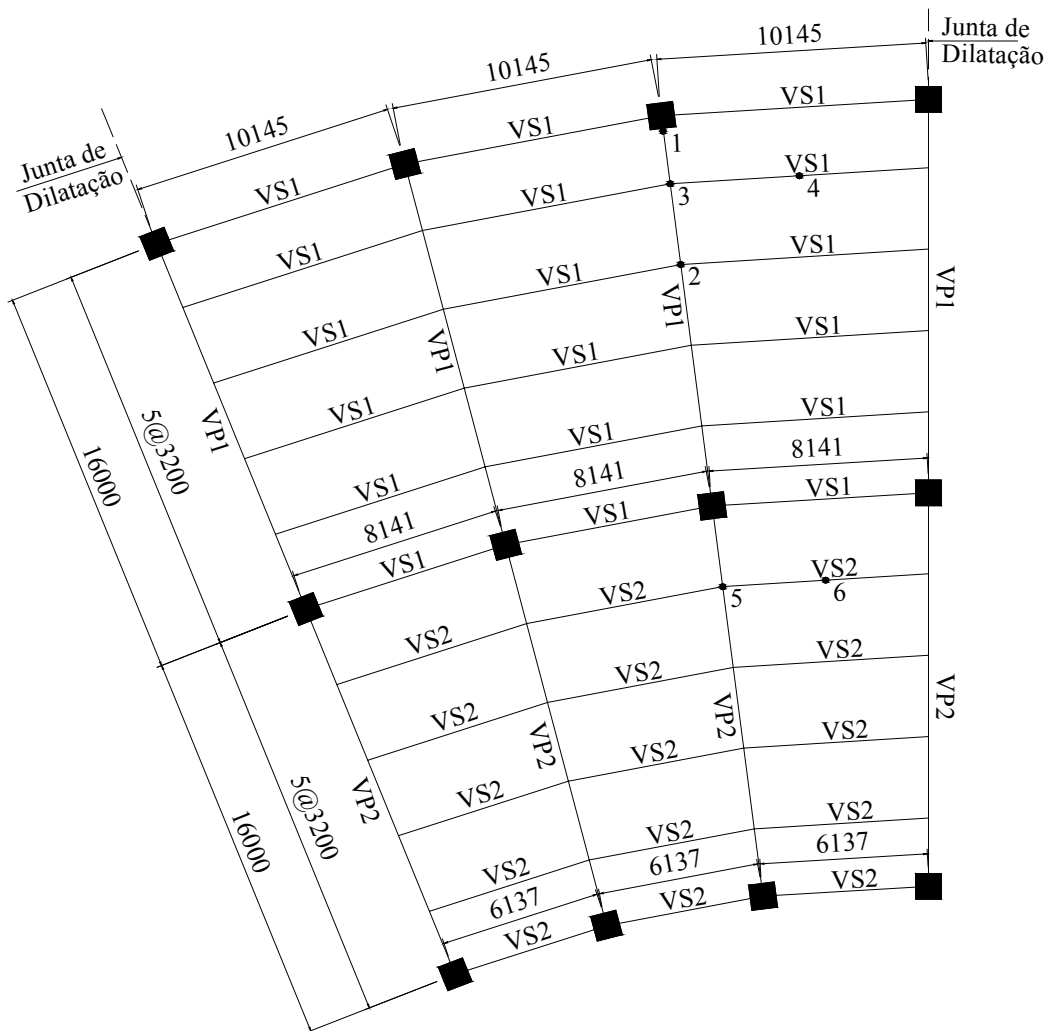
Planta baixa de um pavimento do edifício garagem (EDG) do aeroporto internacional do Rio de Janeiro.
